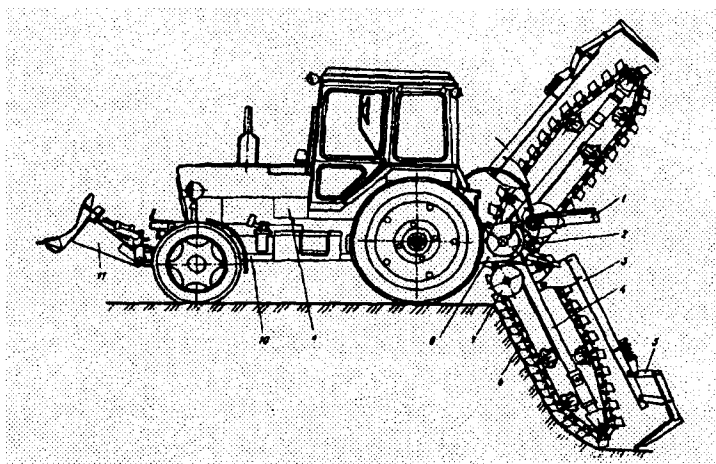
Общий вид многоковшового экскаватора на базе колесного трактора:
